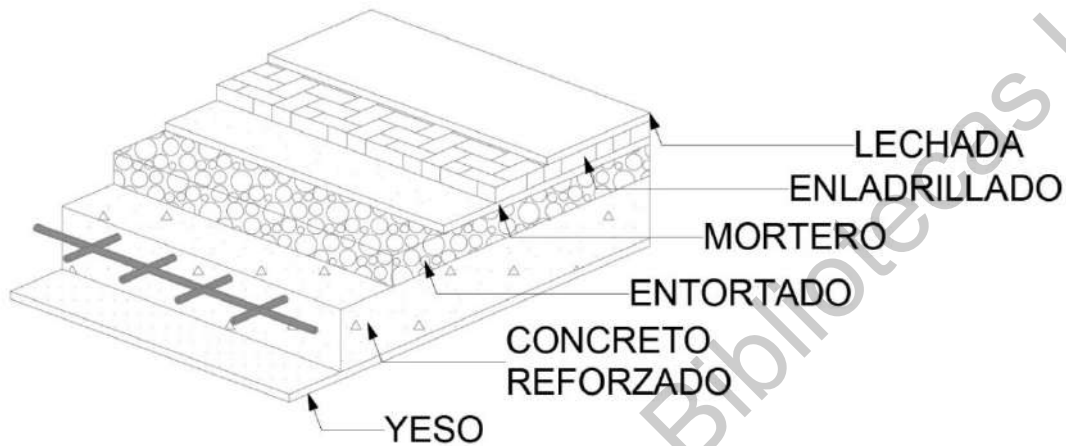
Detalle de losa de azotea con enladrillado. Elaboración propia.
